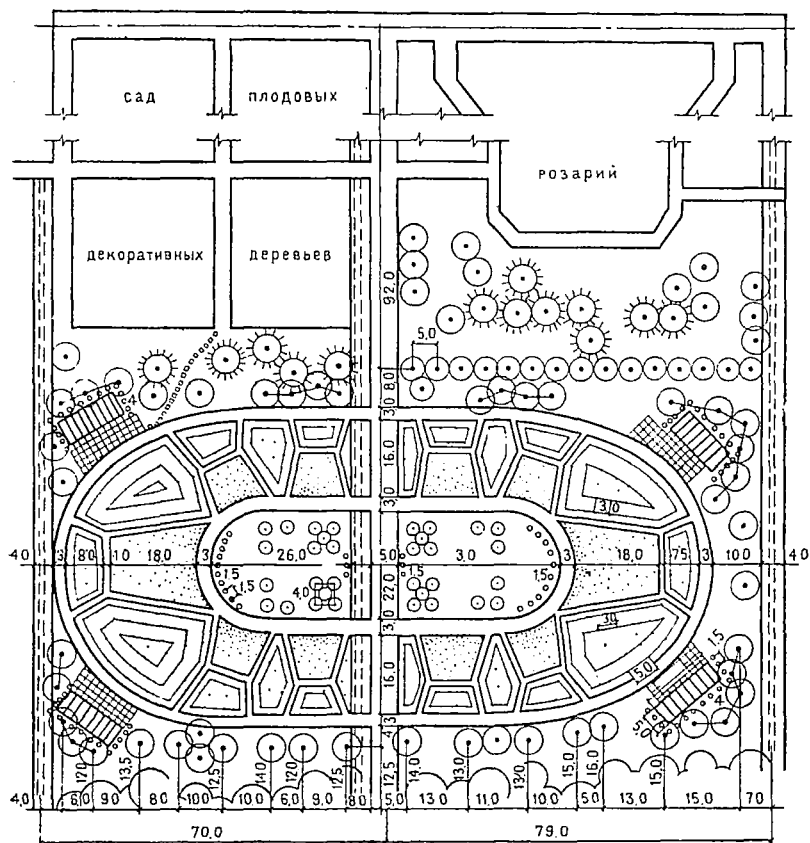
Схема разбивочного чертежа с координатной сеткой
